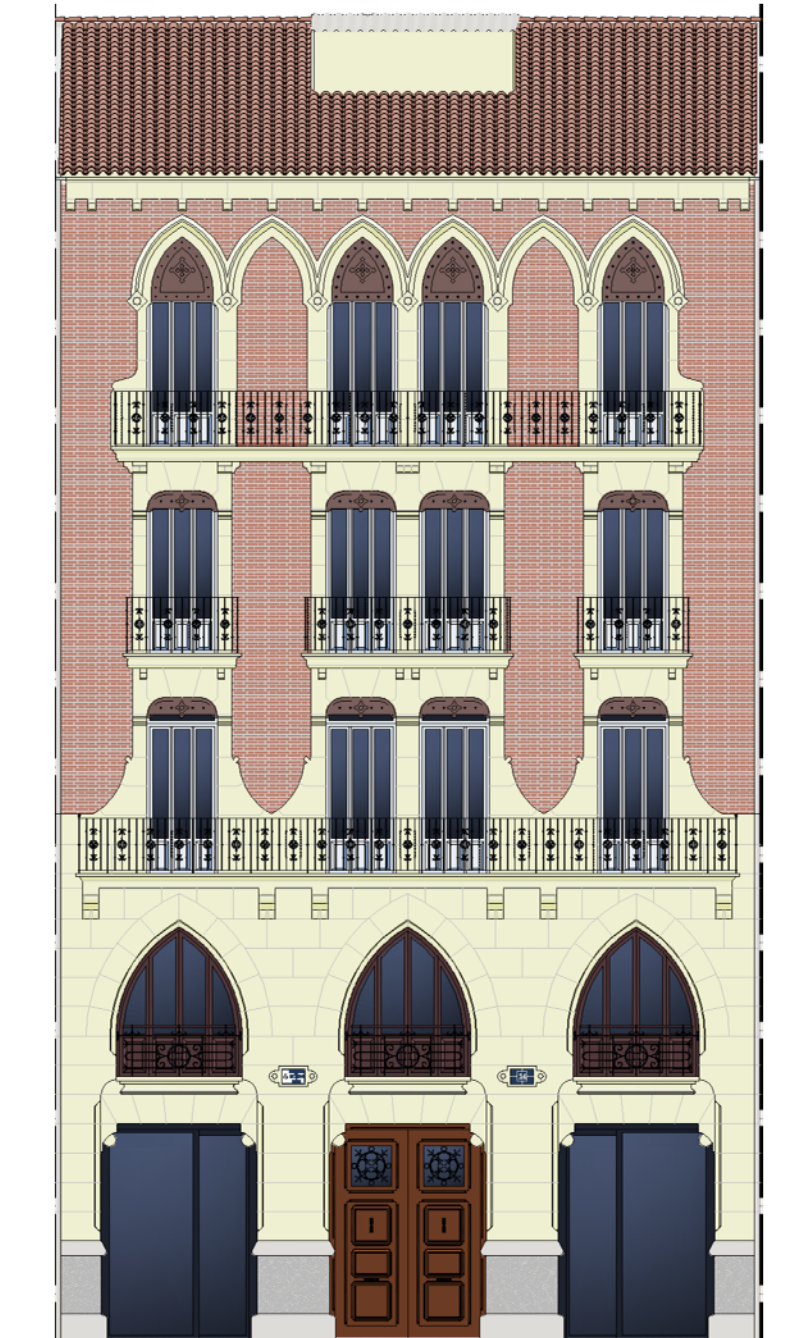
Levantamiento planimétrico fachada principal Sorní nº14. Fuente propia.
